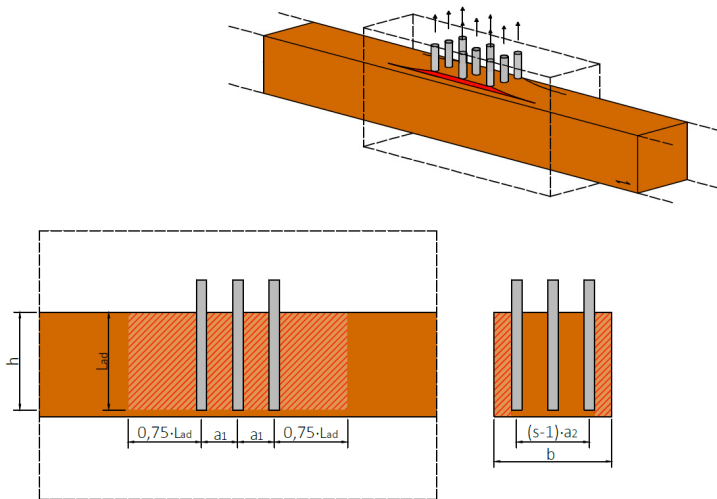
Auf Rollschub beanspruchte Flächen bei einem Versagen der Gewindestangengruppe auf Grundlage des Modells nach Blaß und Flaig [49].
